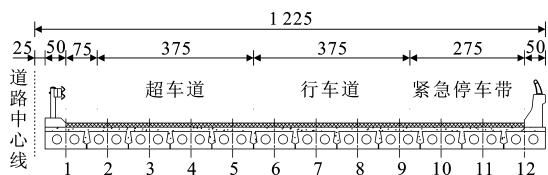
8 m RC 板桥典型横断面布置(单位:cm)
